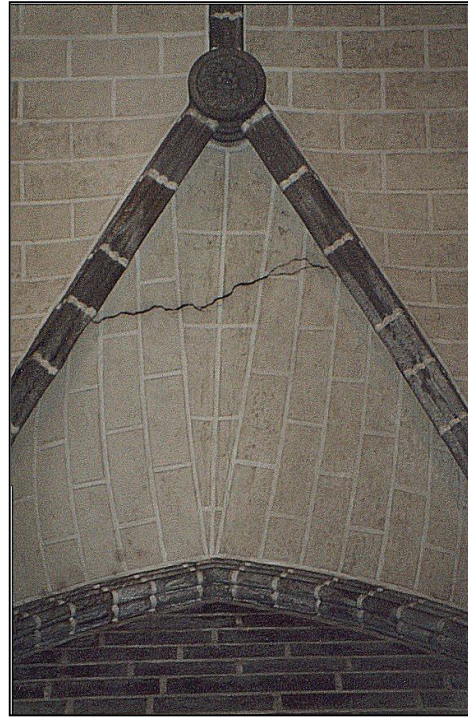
Vista das fissuras existentes no lado direito da abóbada da Igreja.
